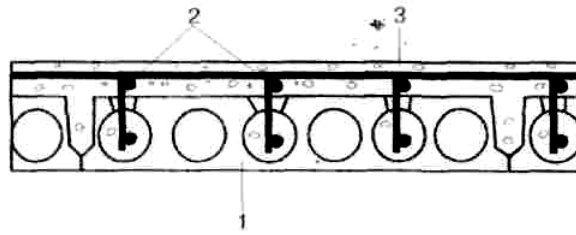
Конструктивна схема підсилення залізобетонних пустотних плит:
